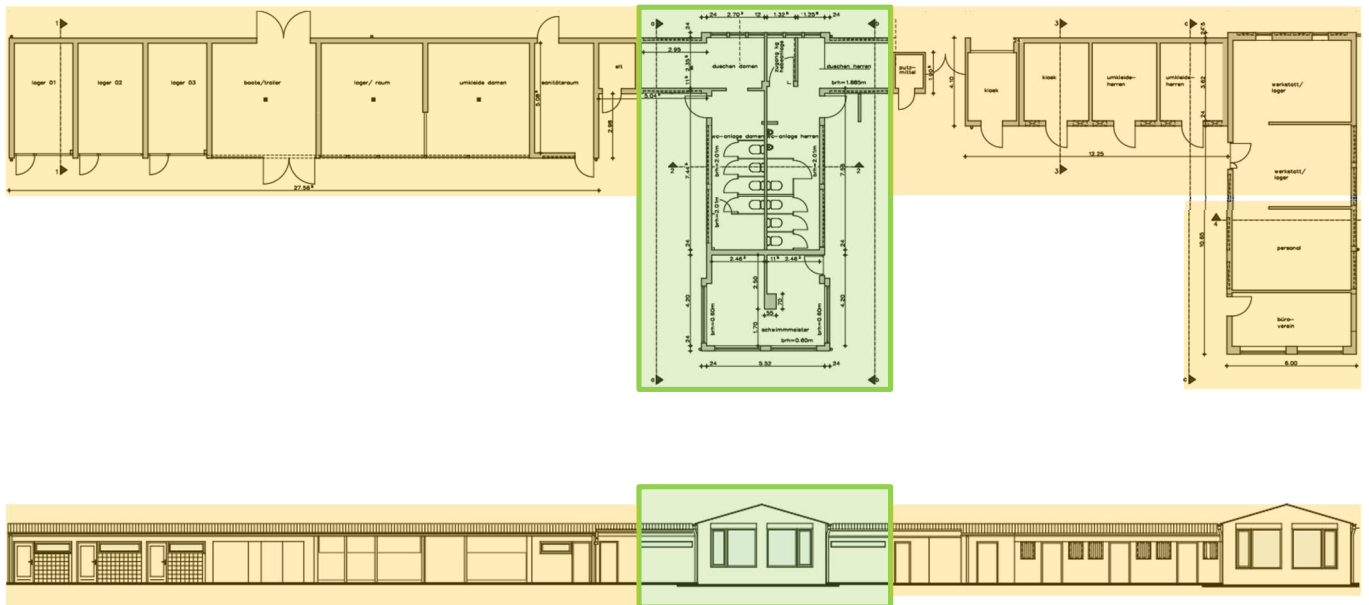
Grundriss und Ansicht Massivbau, grün Hauptgebäude, gelb Nebengebäude
